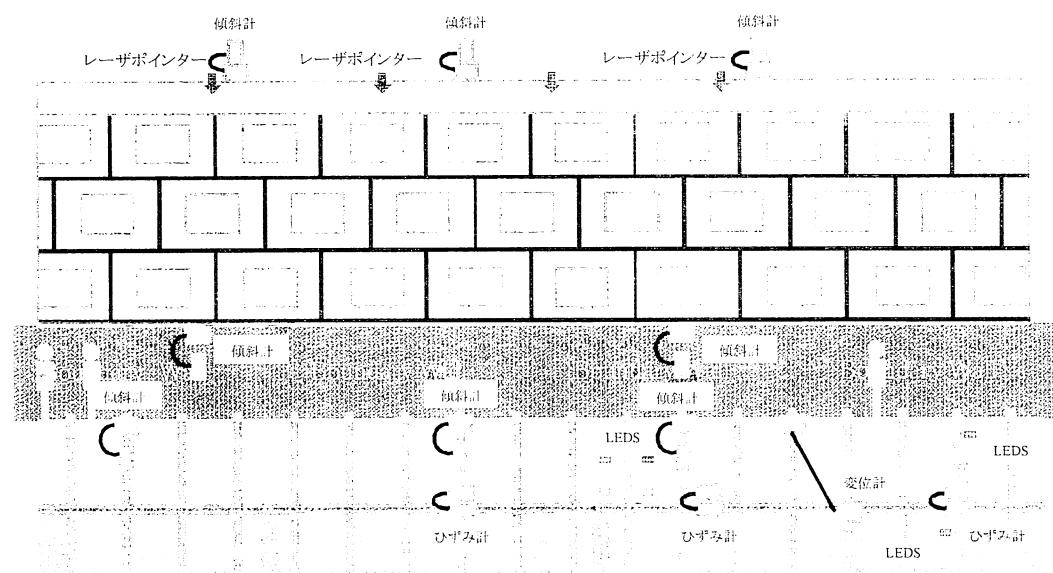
AIIMS駅に設置した光る計測機器の断面配置図
